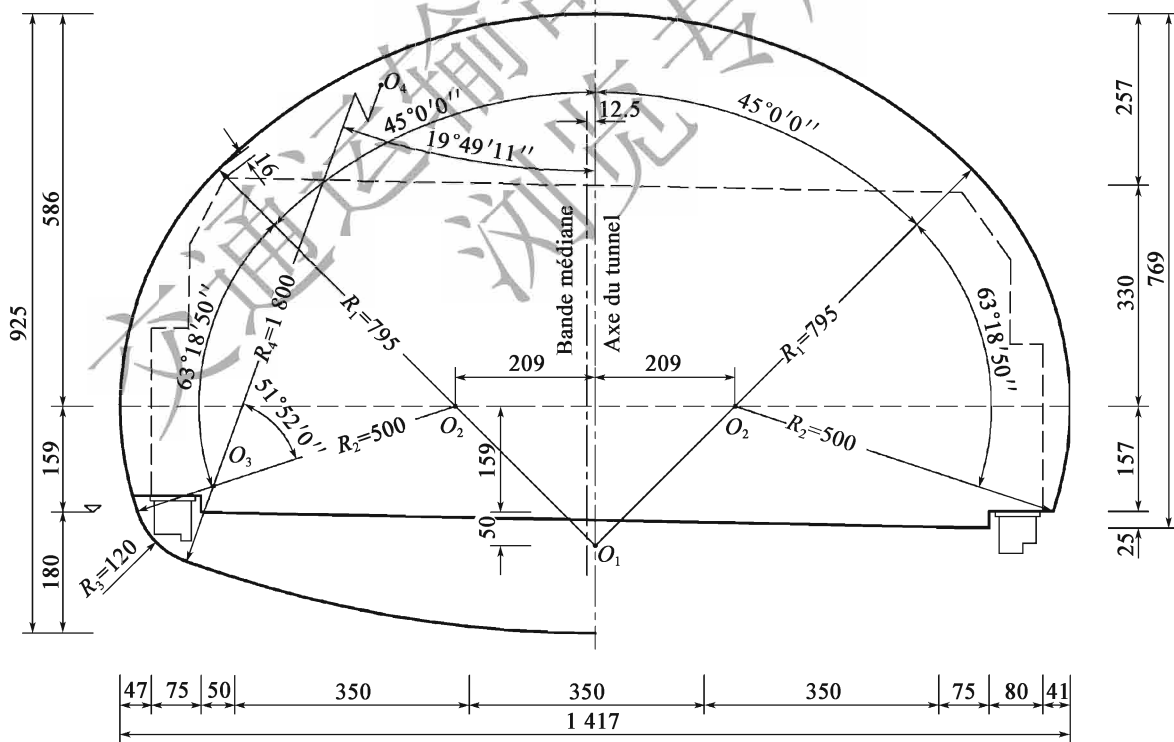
Gabarit du tunnel routier de première classe à trois voies (60km/h) (unité: cm)
